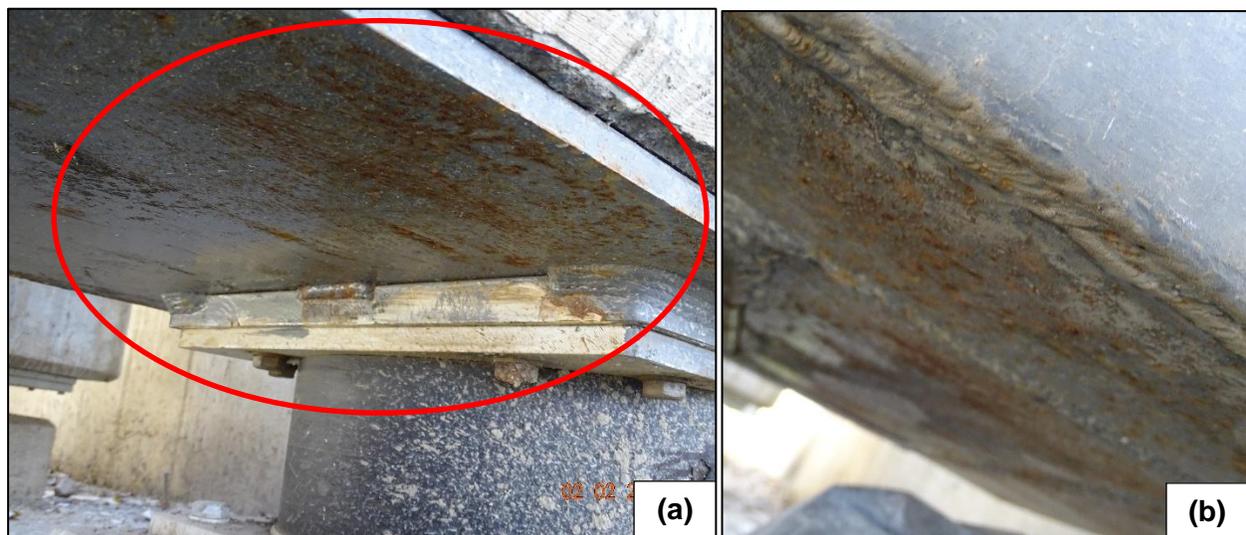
Puntos de oxidación en las placas y los encamisados de acero en los extremos de las vigas principales de las rampas de acceso al viaducto.
